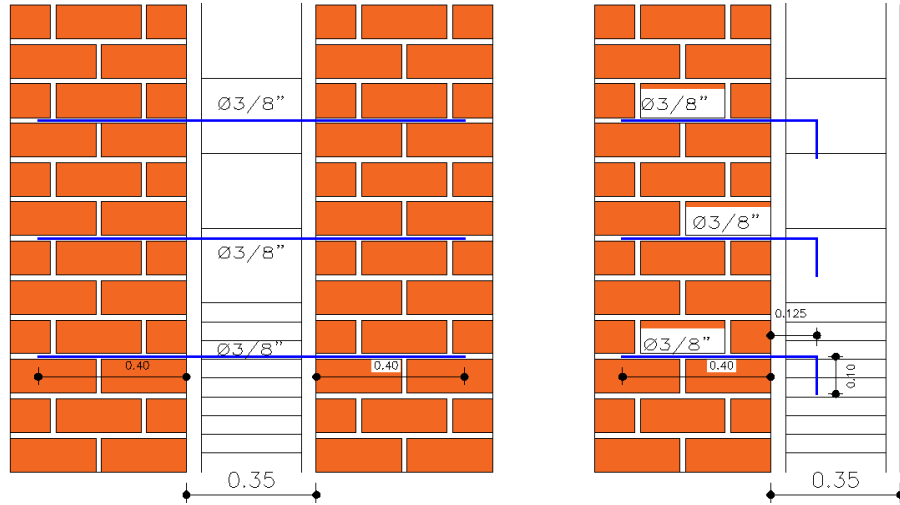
Muro de sogas continuo y en borde con refuerzo horizontal
